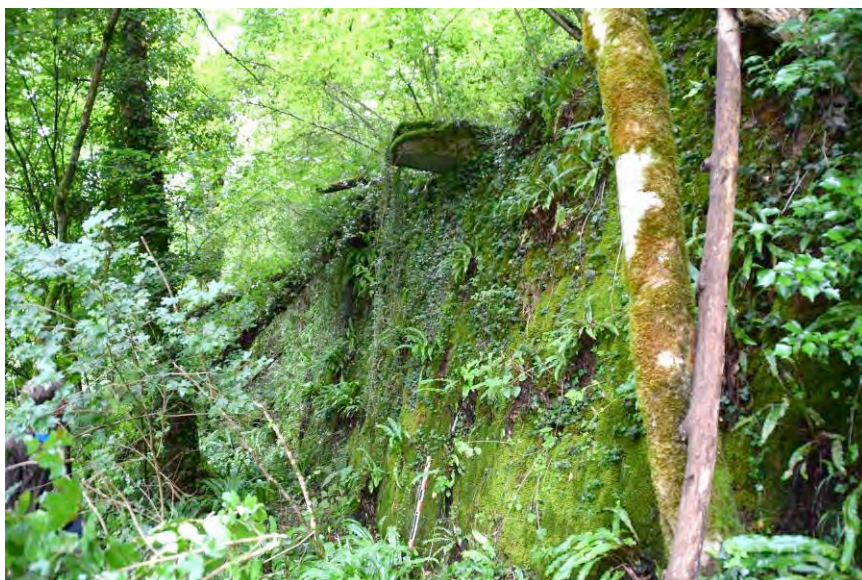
Mur intermédiaire avec corbeau, fours Las Cabesses.
